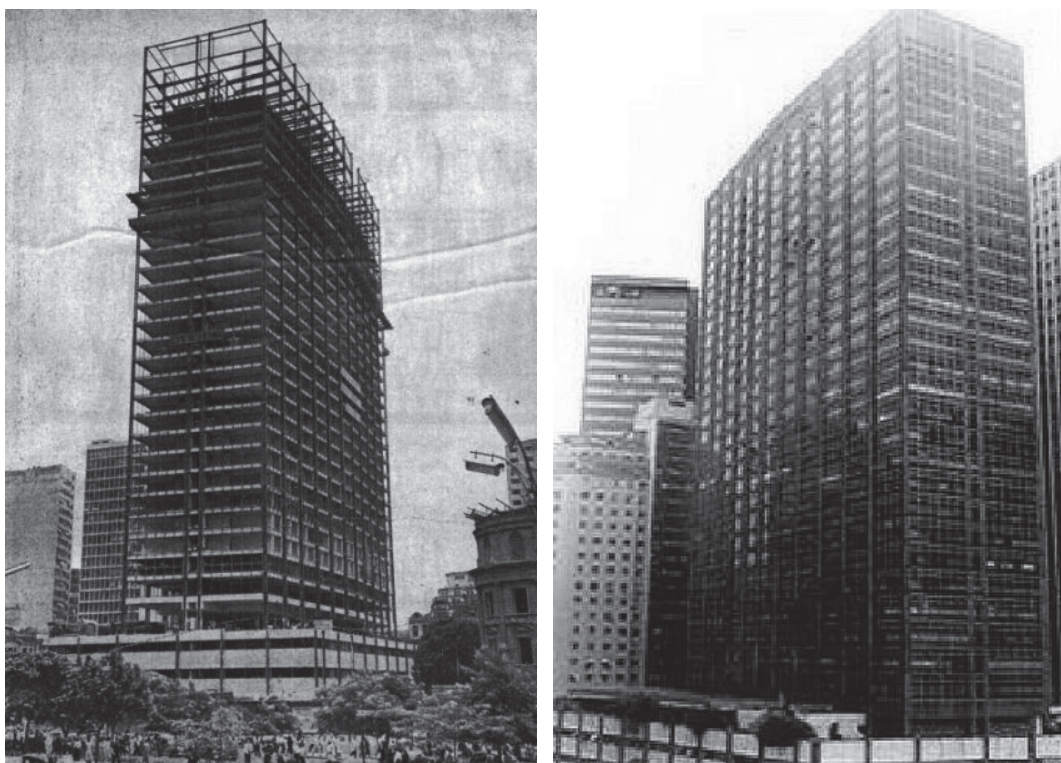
Edifício Avenida Central durante a montagem da estrutura metálica em 1960 e na sua inauguração em 1961 (Fontes: Revista Módulo, nº 17, 1960)
